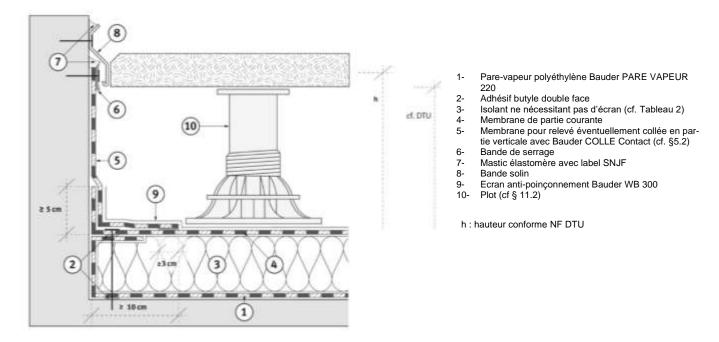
Relevé d'étanchéité en toiture accessible piéton et séjour sur support en maçonnerie d'aspect lissé au sens du NF DTU 21.
